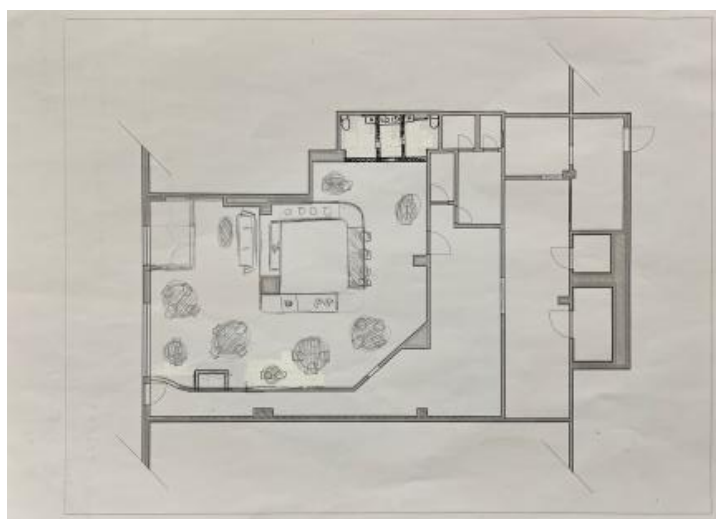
Planta de estudo 5. Fonte: Autora, 2025
